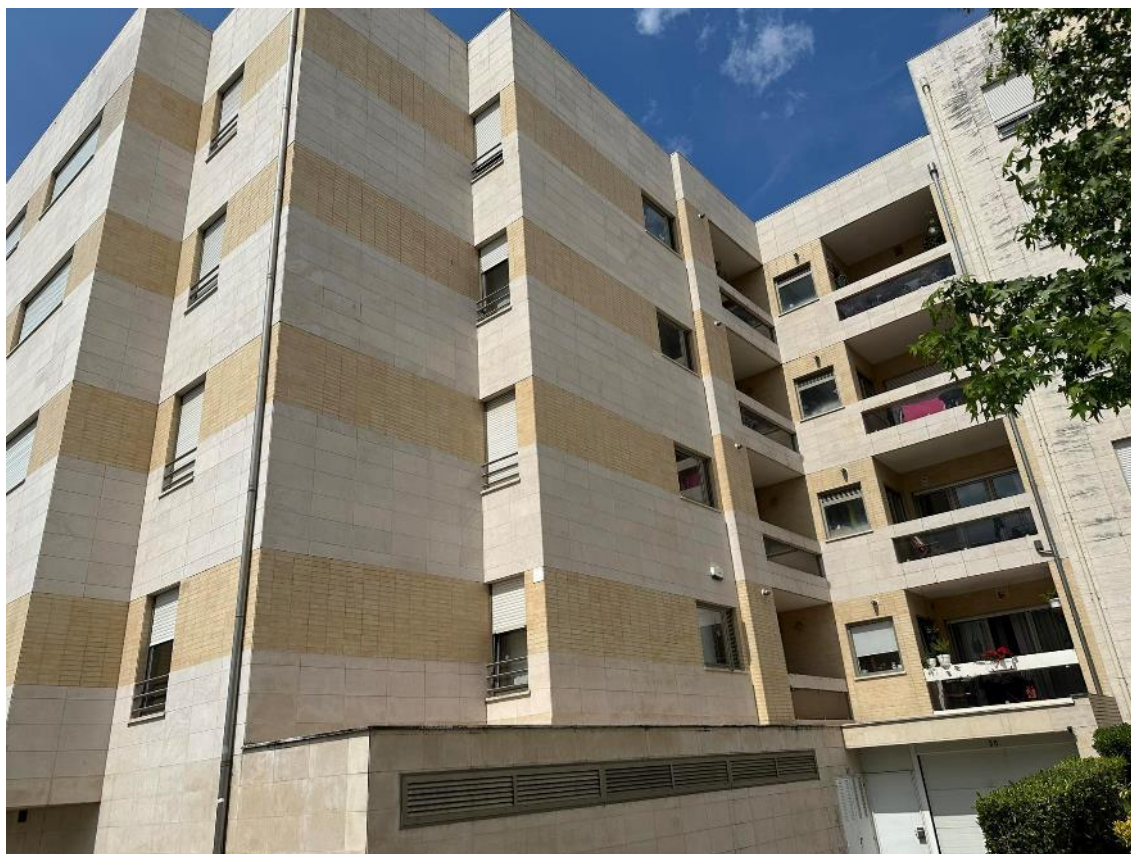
Fachada orientada a Norte do caso de estudo 1.
